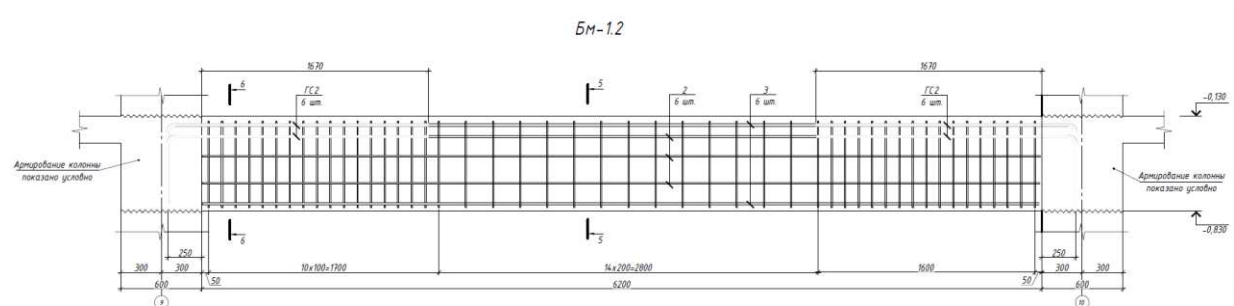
Схема армирования монолитной железобетонной балки
